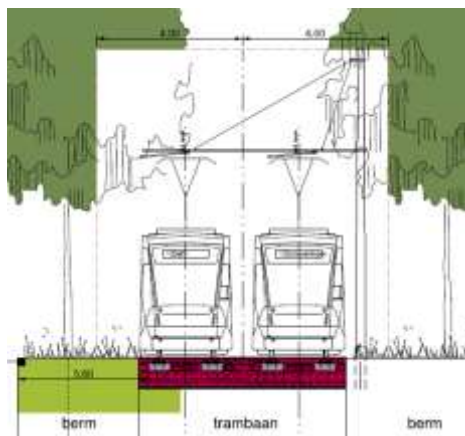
huidige ligging, spoorconstructie op palen betonplaat
